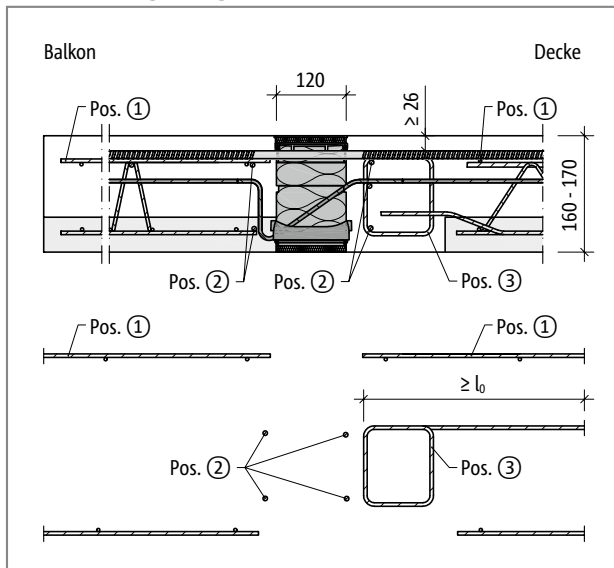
Schöck Isokorb® CXT Typ K-F: Bauseitige Bewehrung bei Balkonplattendicke $h = 160 - 170$ mm
